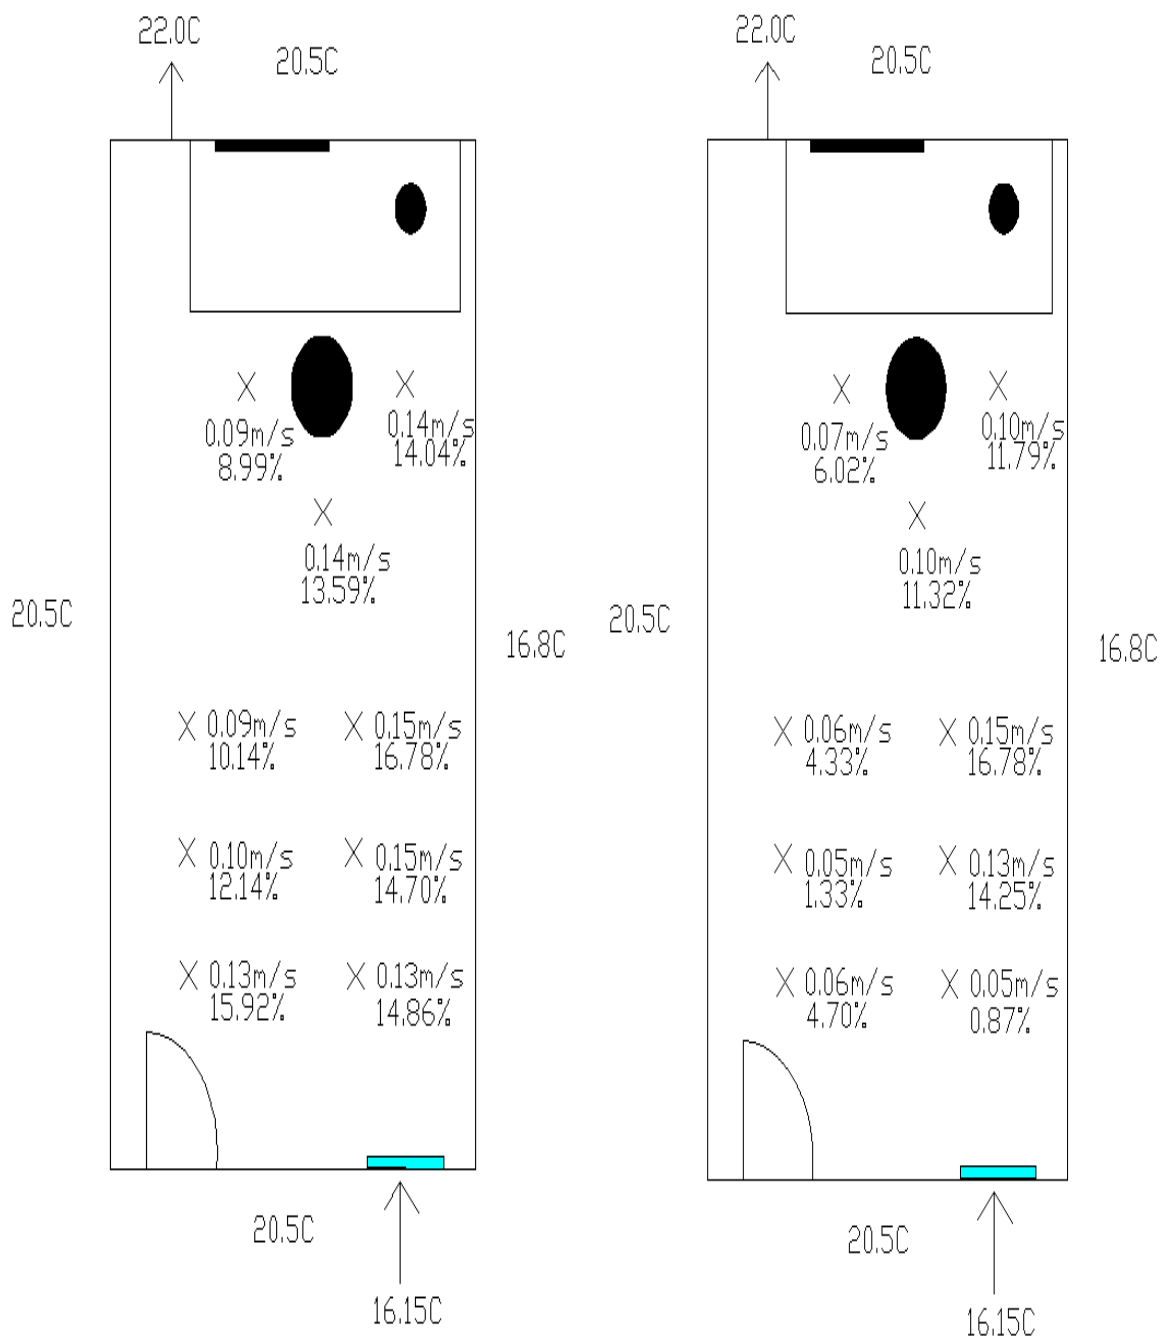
Til venstre: 5cm over gulvet. Til høyre: 10cm over gulvet.
